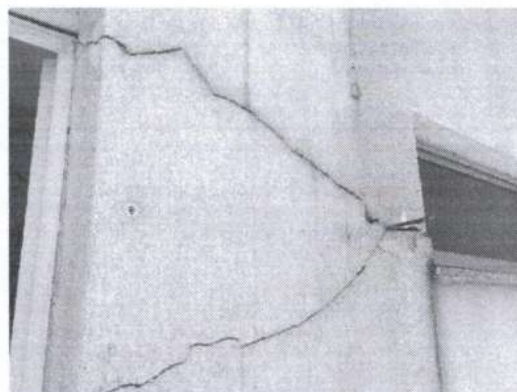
Trincas entre esquadrias localizadas na fachada – trechos de alvenarias desconectadas
